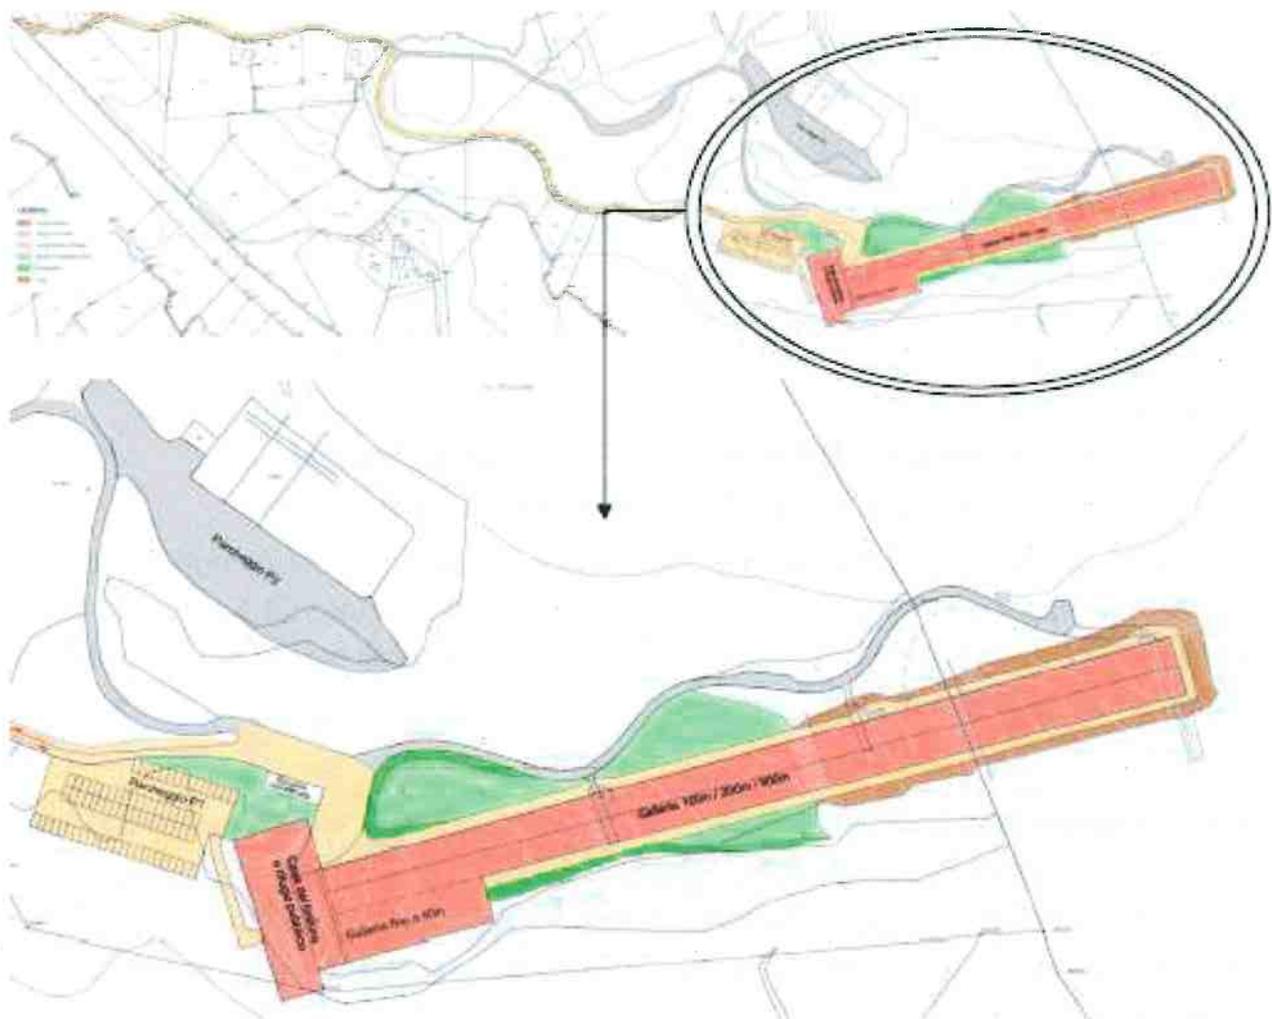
Planimetria generale del progetto (Lucchini & Canepa Ingegneria SA)
